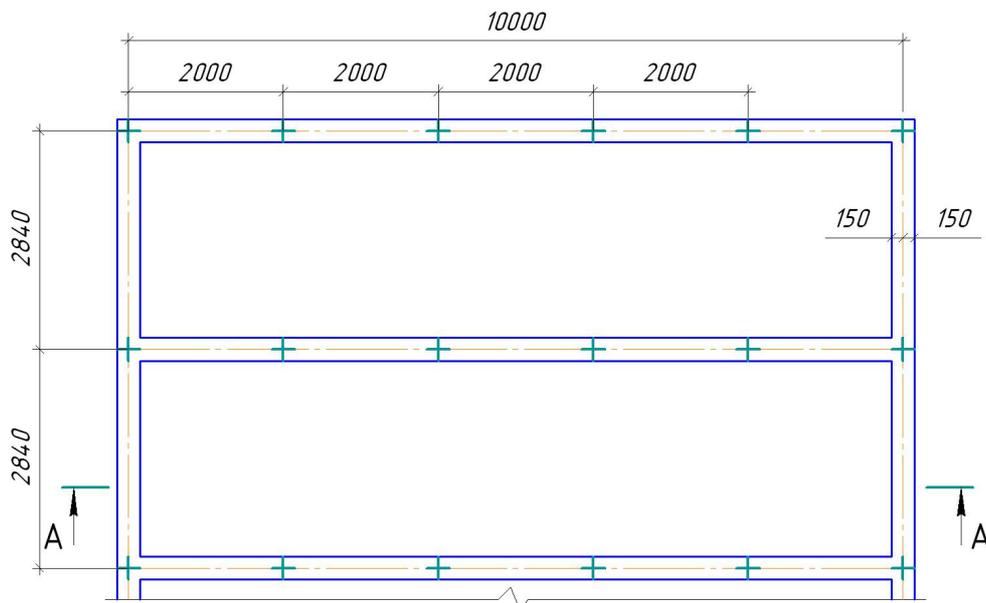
Схема плана ростверка под модельное здание длиной 10 м
